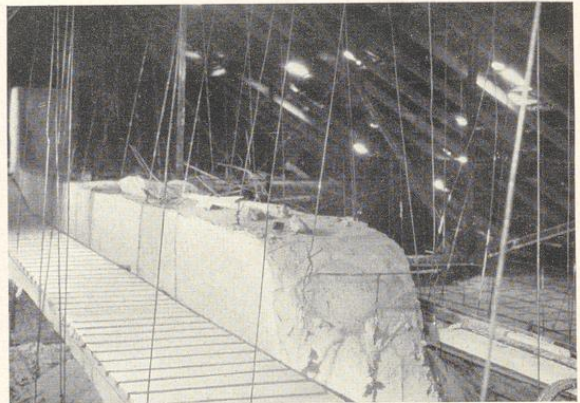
An Dachkonstruktion aufgehängter Entlüftungskanal und Laufboden
